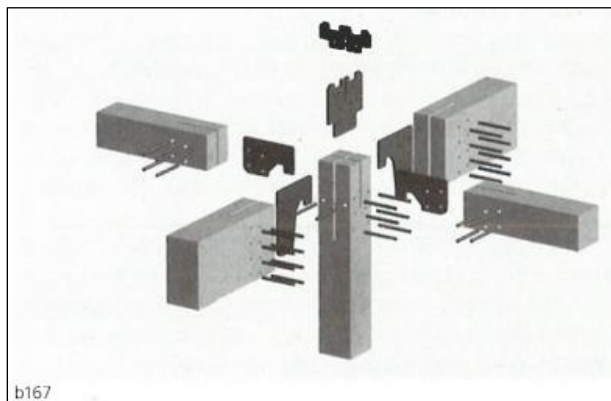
Detail 3, explosietekening kolom-ligger verbinding
